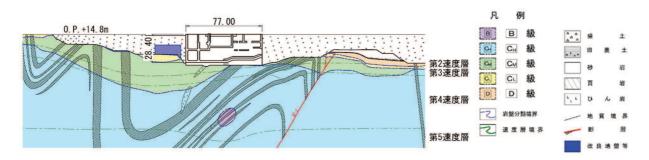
地盤改良体の配置図(海水ポンプ室縦断, D-D 断面)
